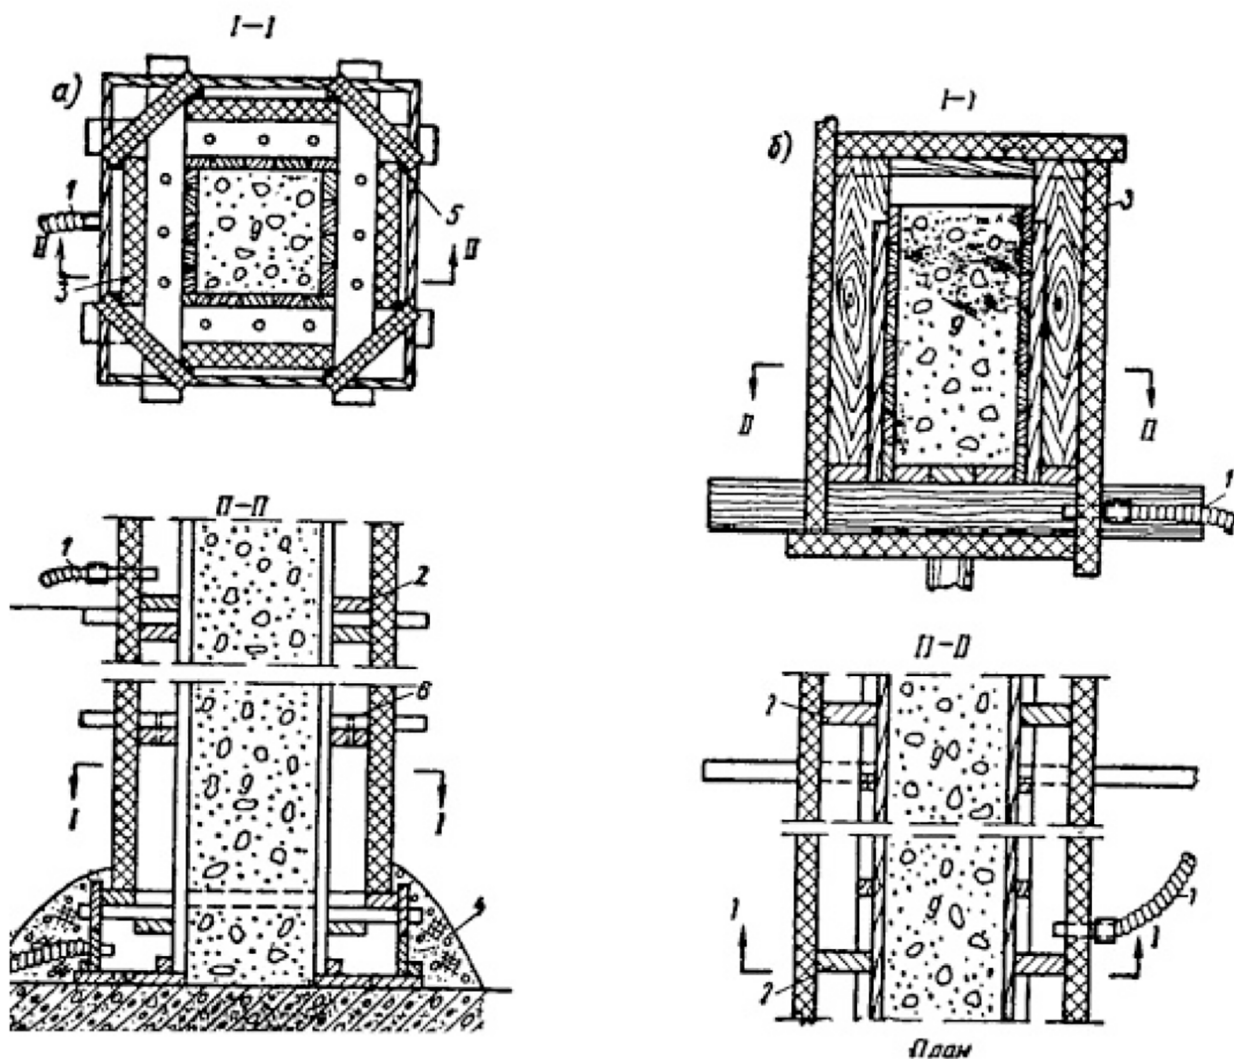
Схемы устройства опалубки при обогреве бетонных и железобетонных конструкций паром или горячим воздухом: а – колонн; б – балок; 1 – гибкий шланг; 2 – заглушка; 3 – утепленные щиты; 4 – опилки; 5 – конопатка щелей войлоком; 6 – отверстия в схватках
